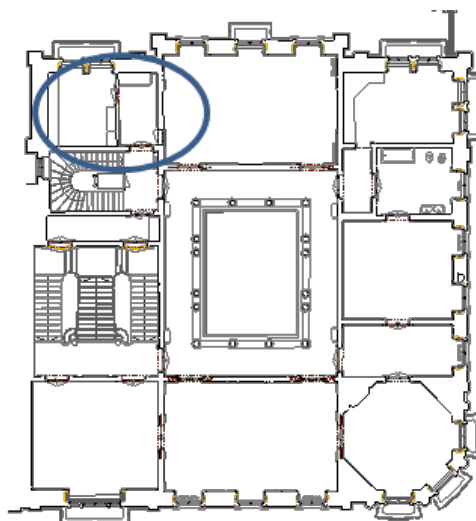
P R C - Planta Piso 0 em 2014.
